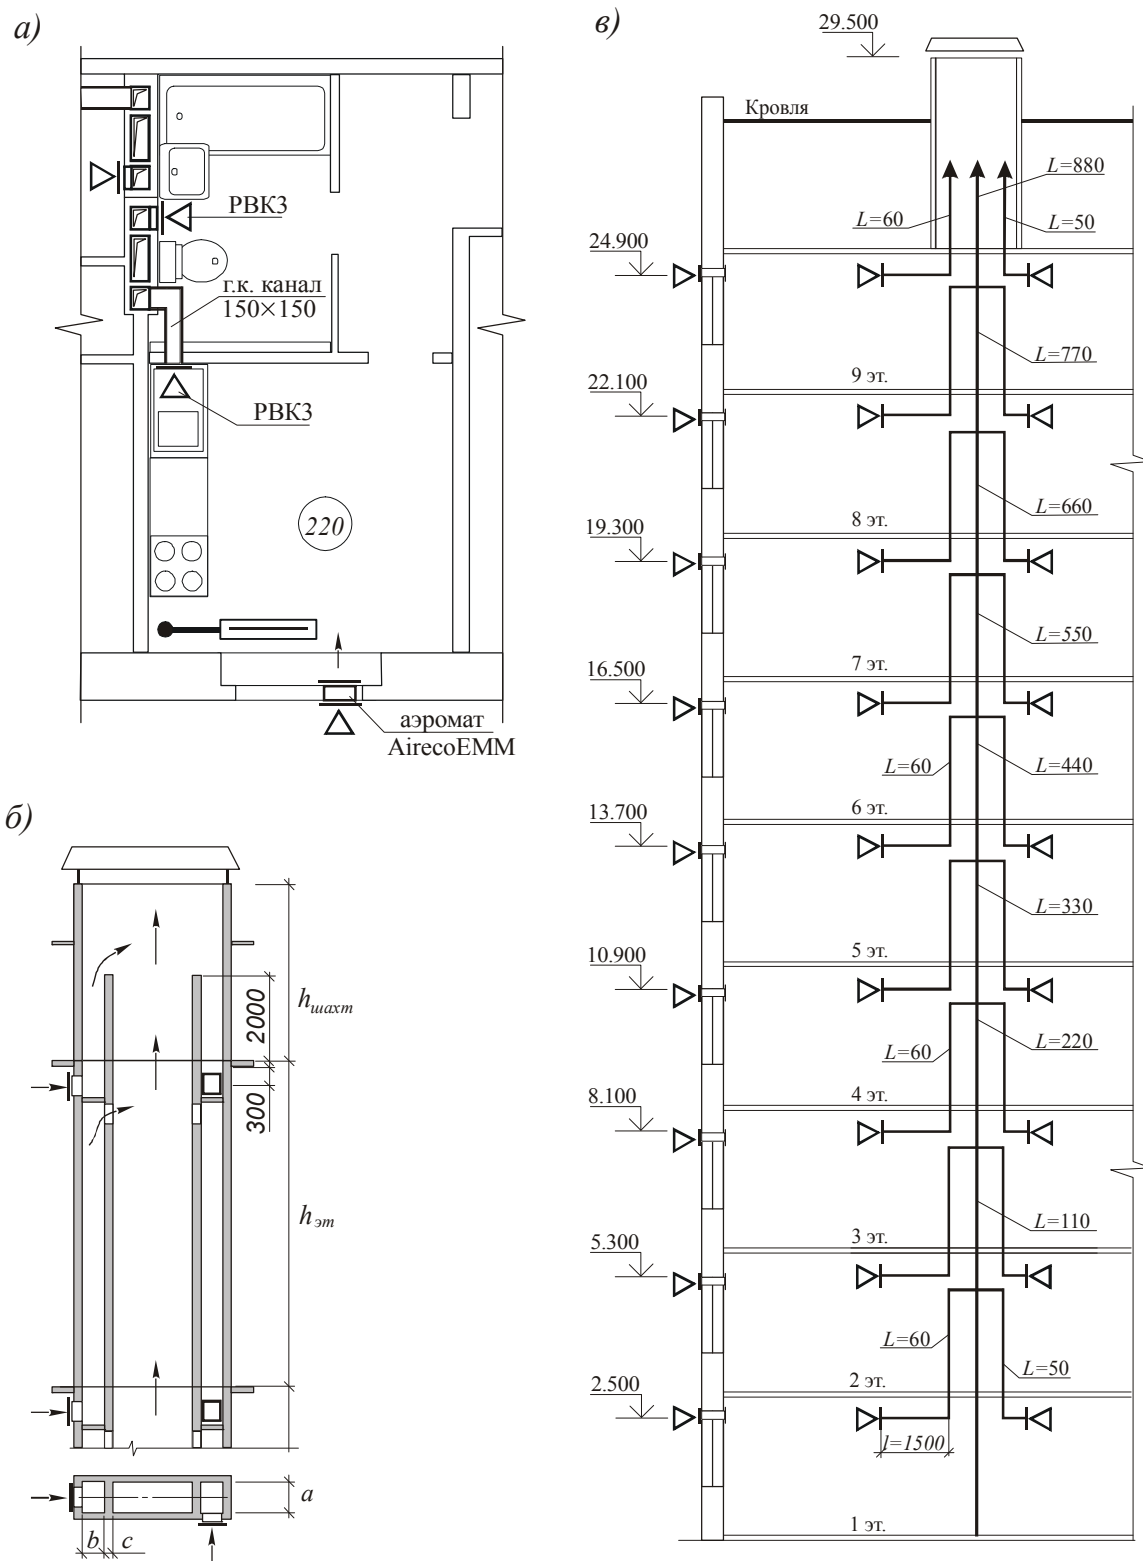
К примеру 25. Вентиляция 9-этажного жилого дома:
